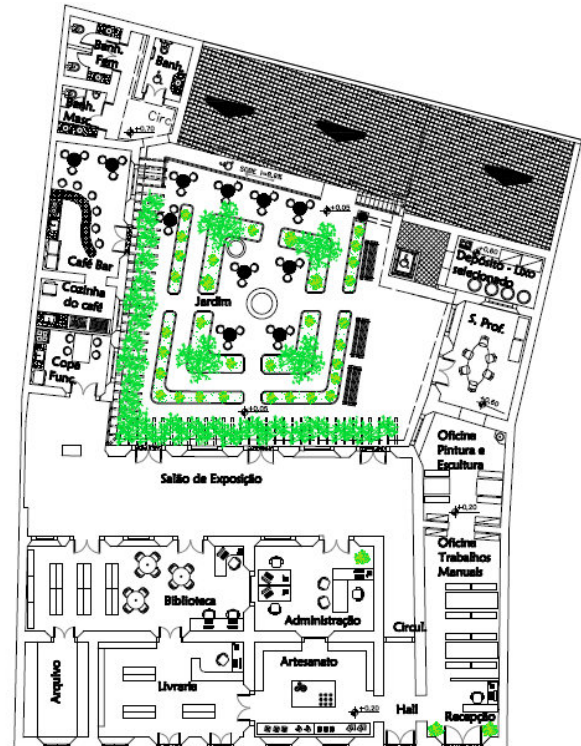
Proposta de uso - Planta-baixa bloco 1
